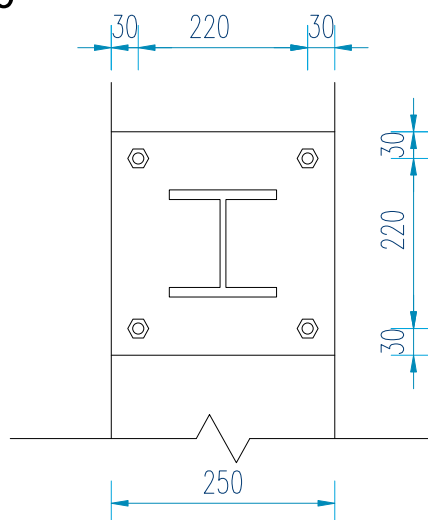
Vista frontal da ligação metálica do perfil no pilar de betão armado
